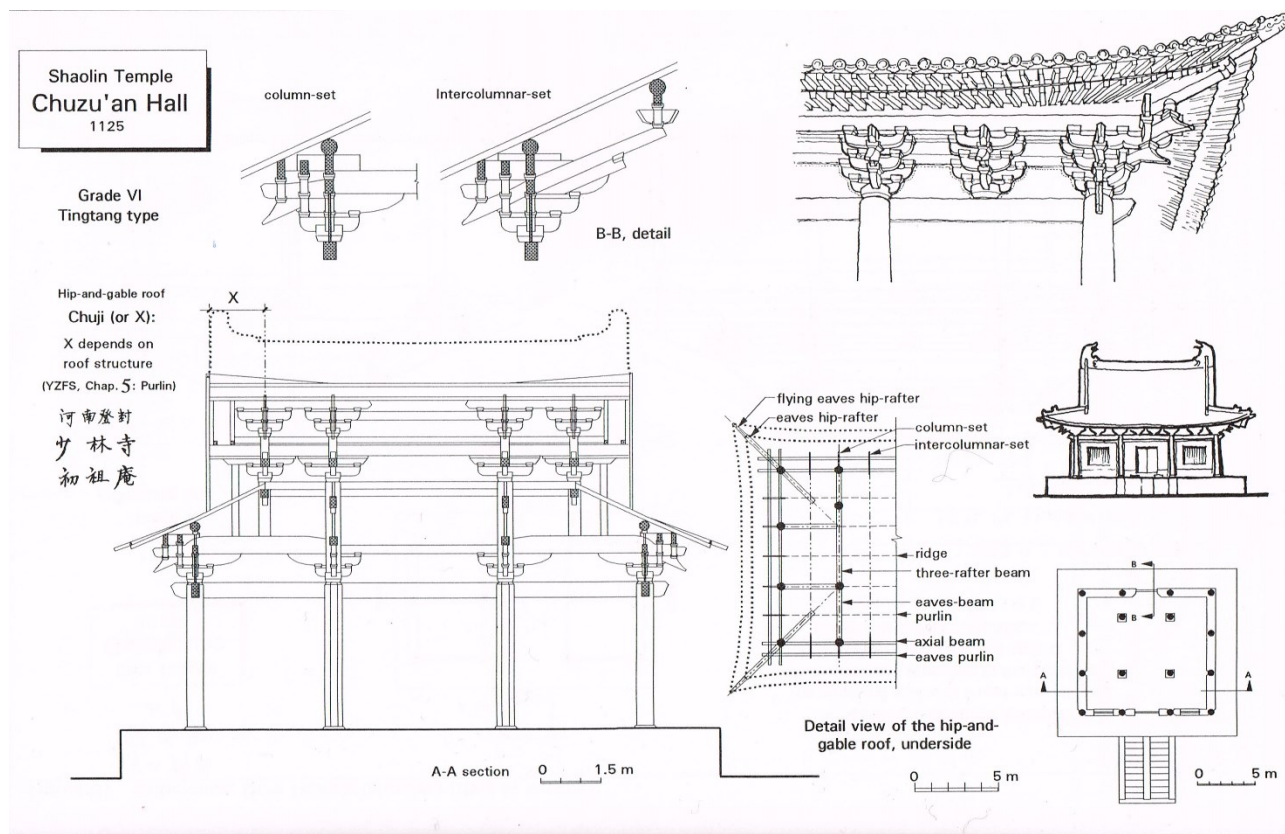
Chüzǔ'ān-Tempel (初祖庵) des Shaolin-Klosters. Querschnitt, Aufriss, Ansicht, Grundriss und Details (Guo 1995, 157).
